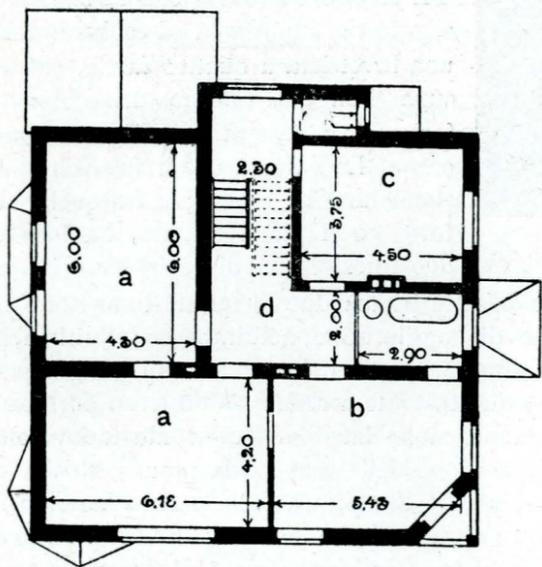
Pianta primo piano - a stanza letto - b stanza letto matrimoniale - c stanza forestieri - d anticamera.
